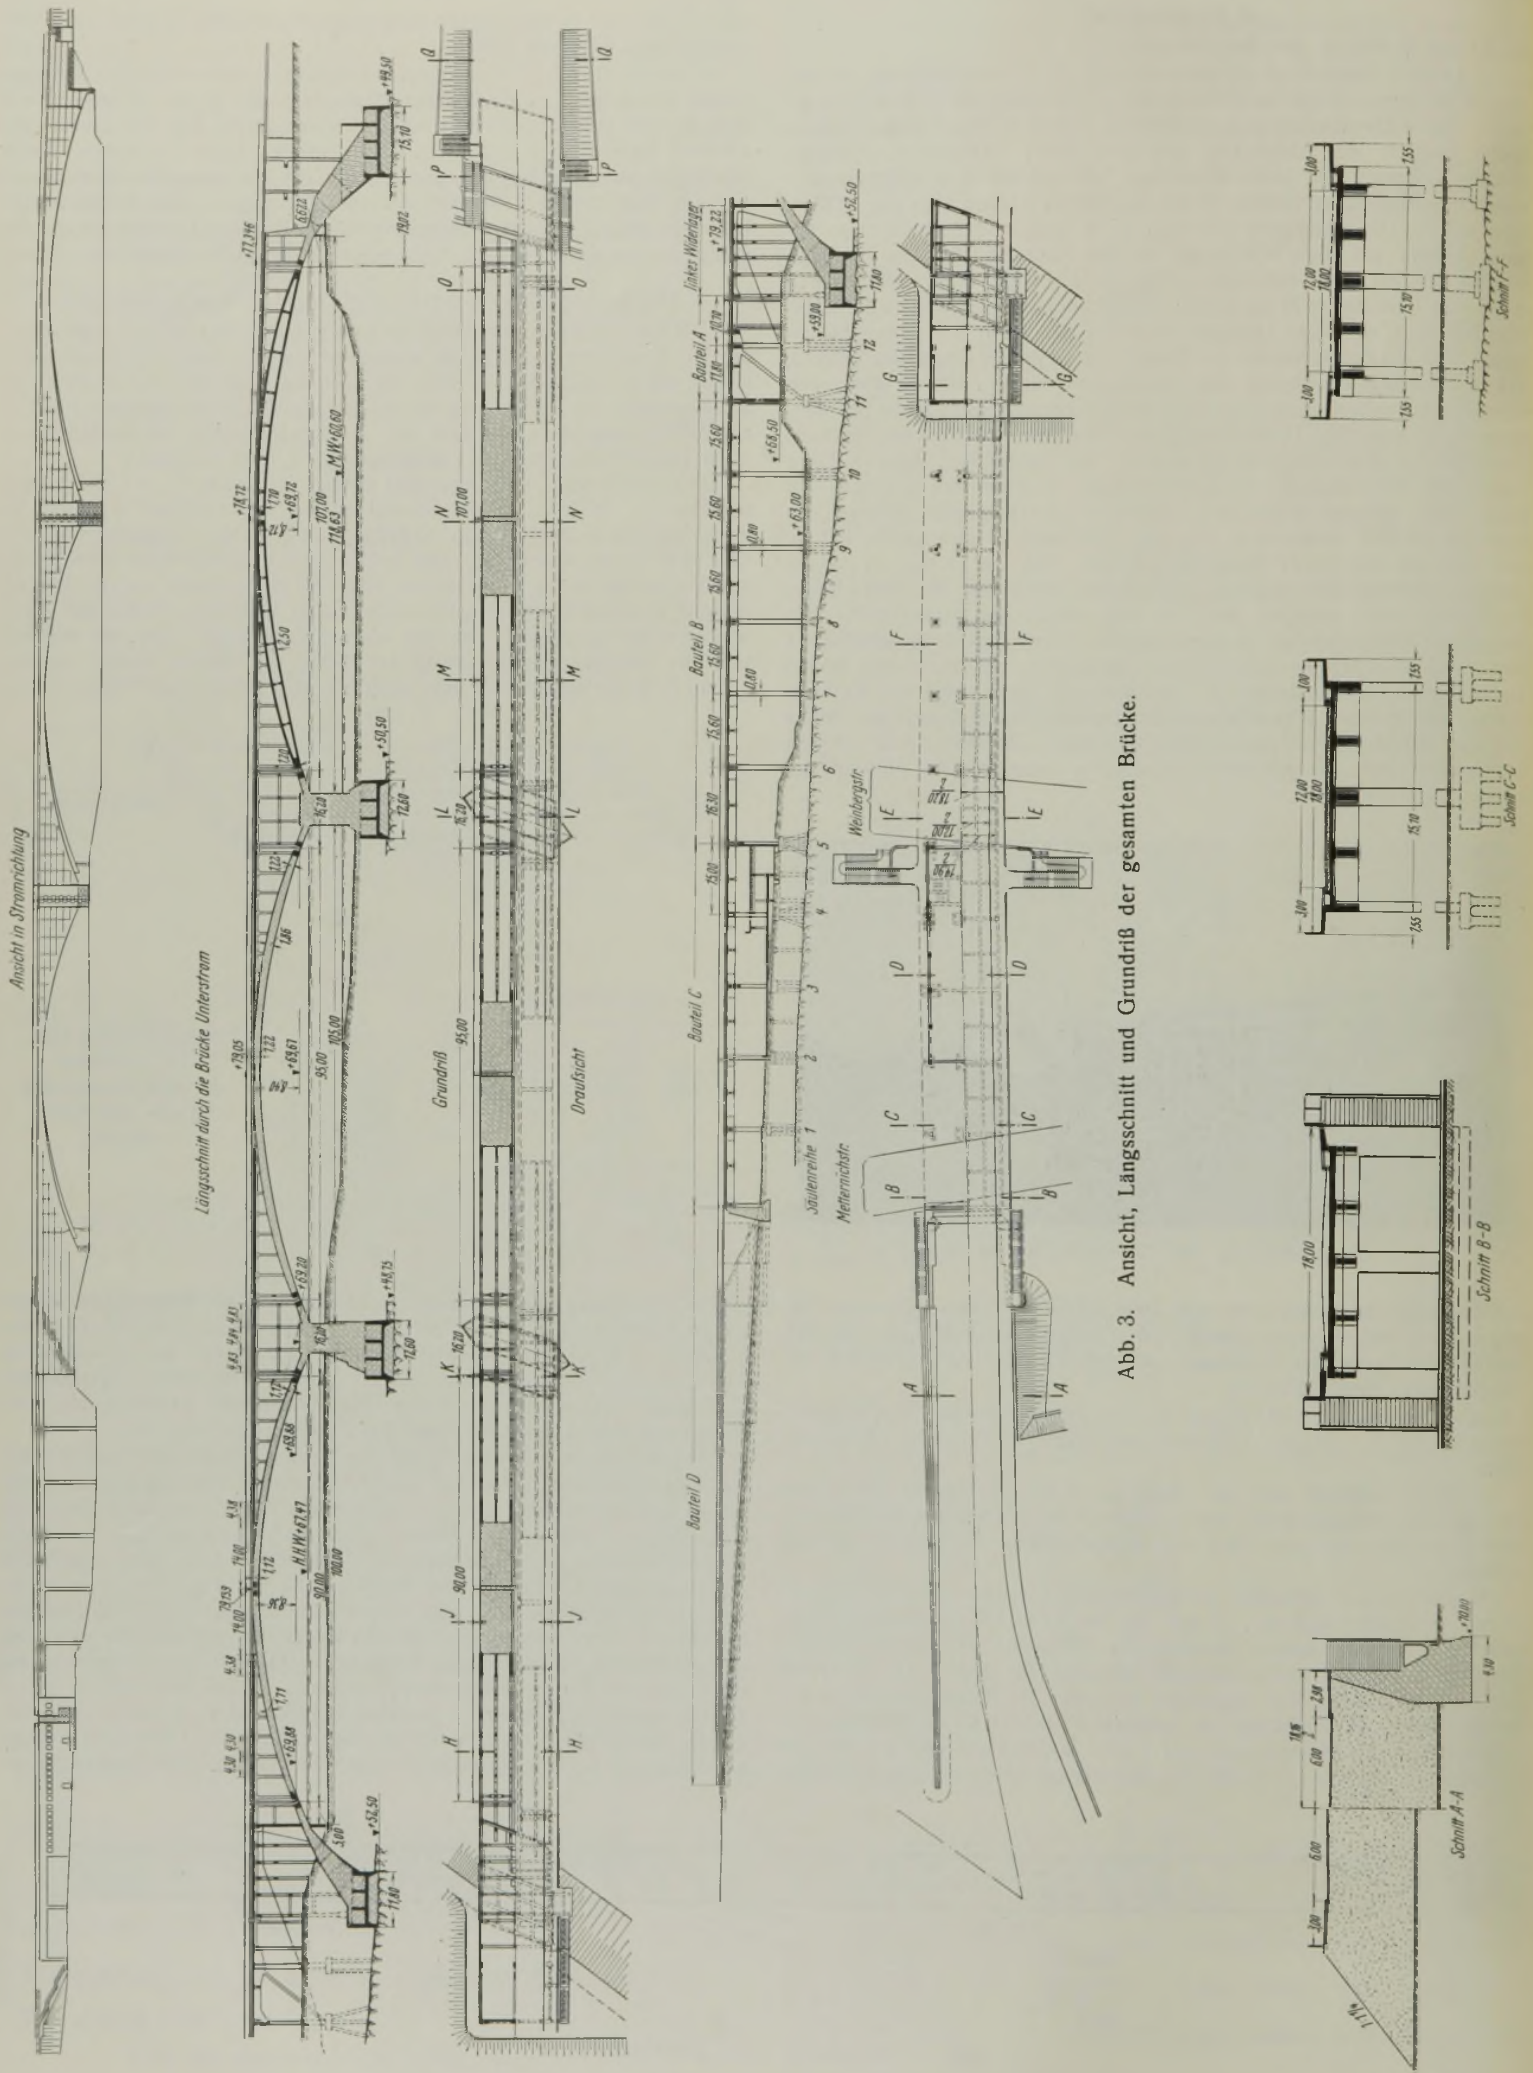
Ansicht, Längsschnitt und Grundriß der gesamten Brücke.
